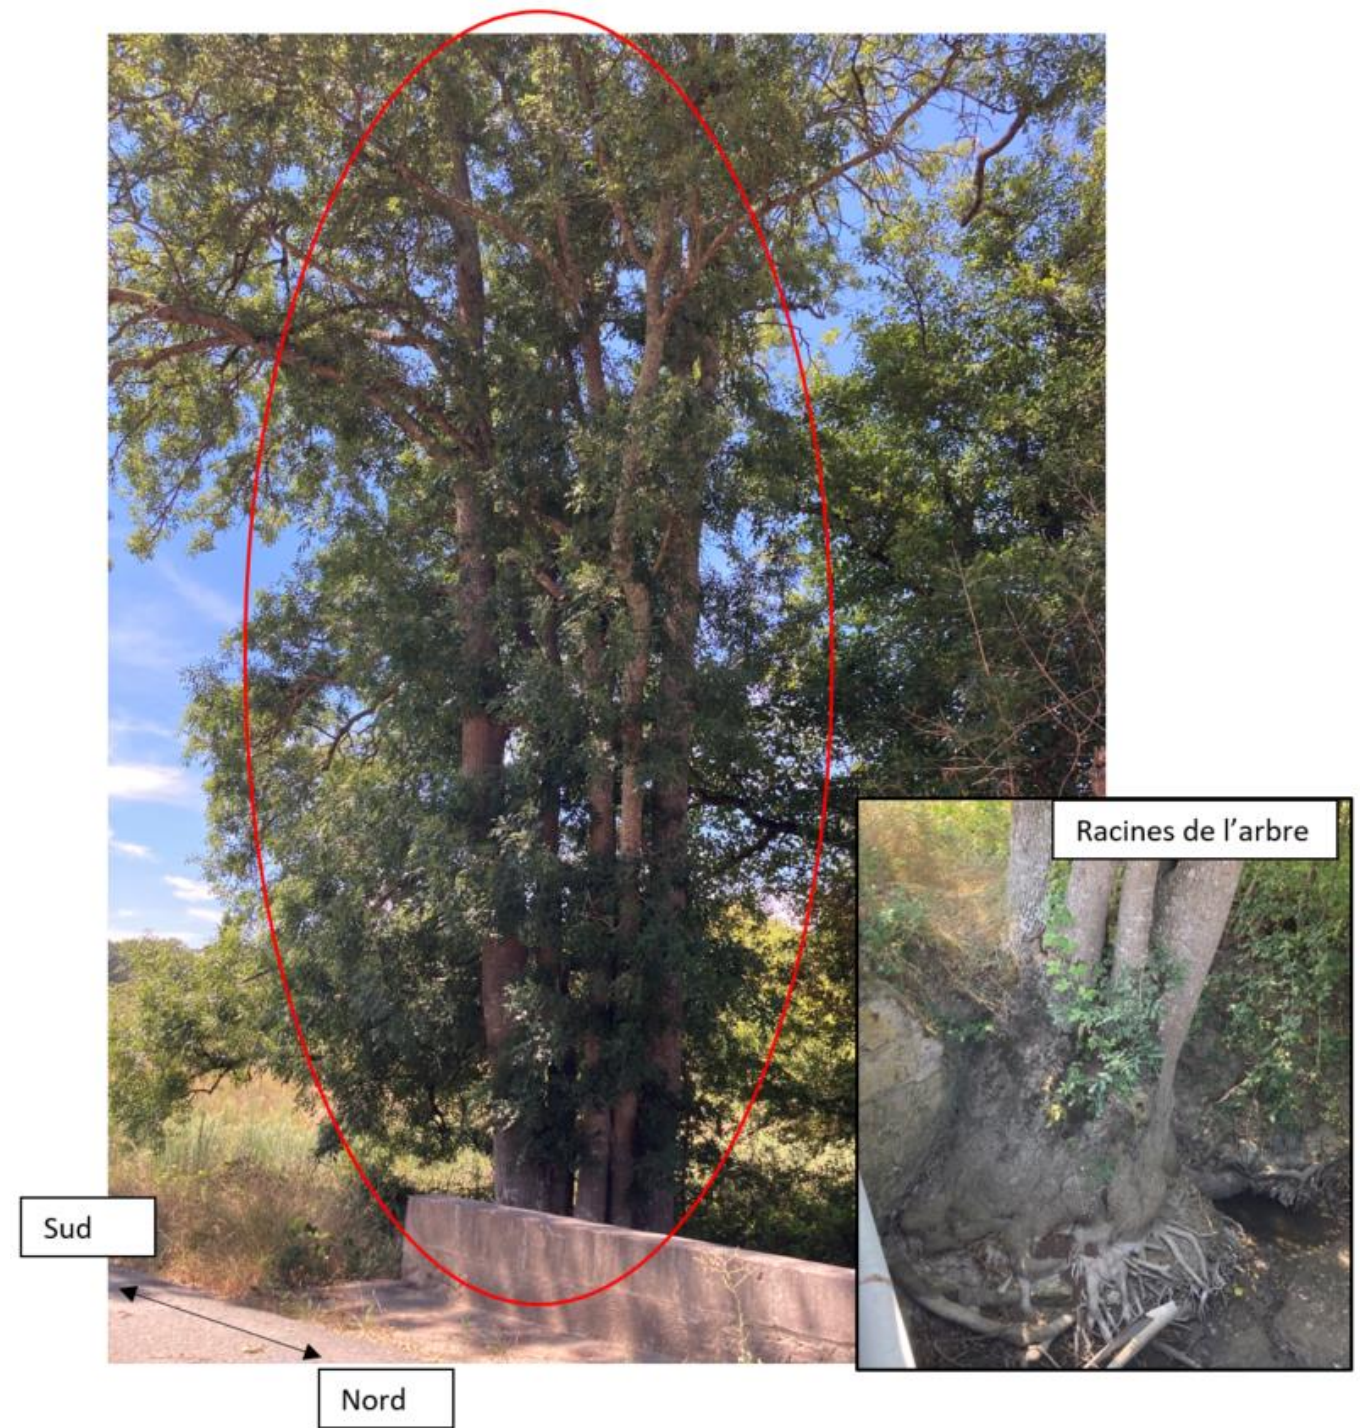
Arbre abattu au sud-ouest – réseau racinaire dans les fondation du pont
